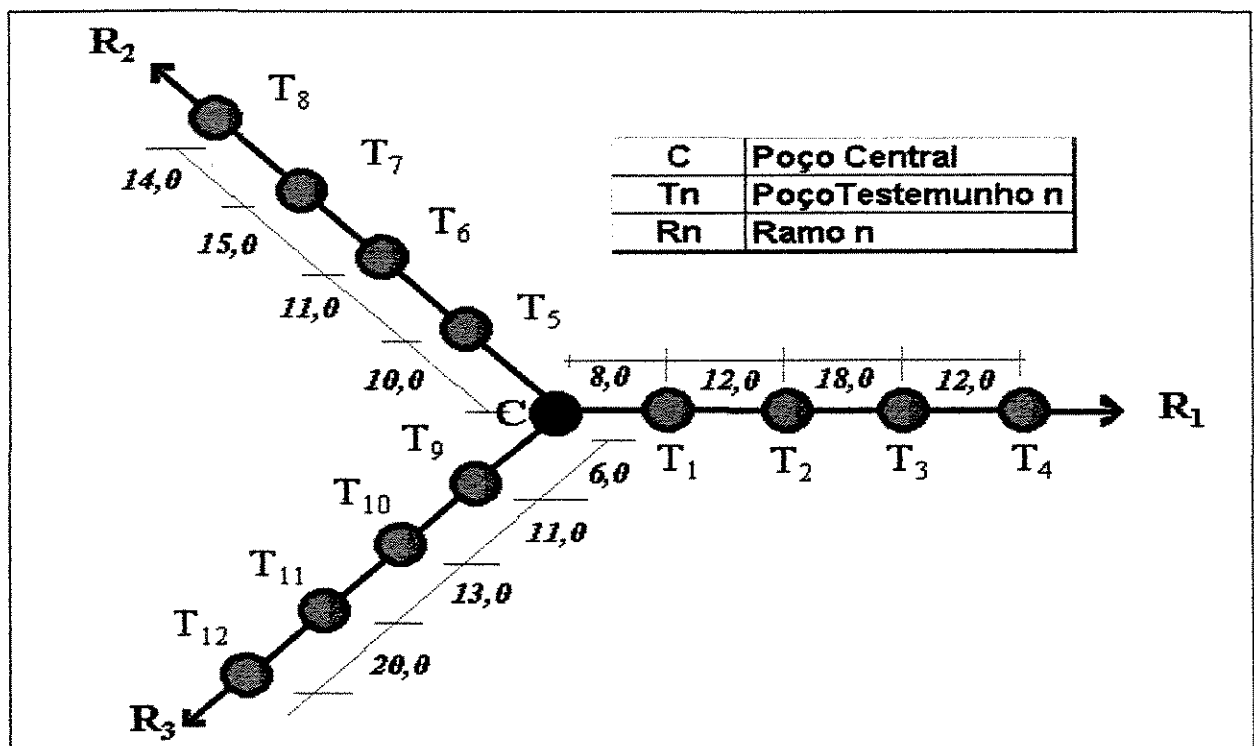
Disposição em planta dos poços testemunhos e do central.
